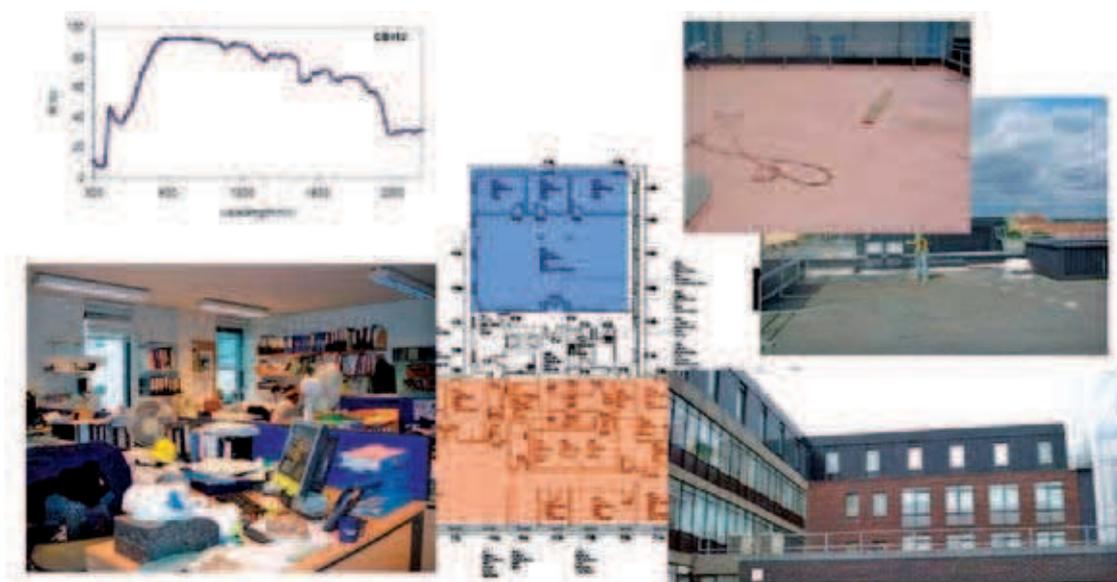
Pianta, fotografie dell'ufficio e della copertura, e riflettanza solare del materiale Cool Roof adottato
